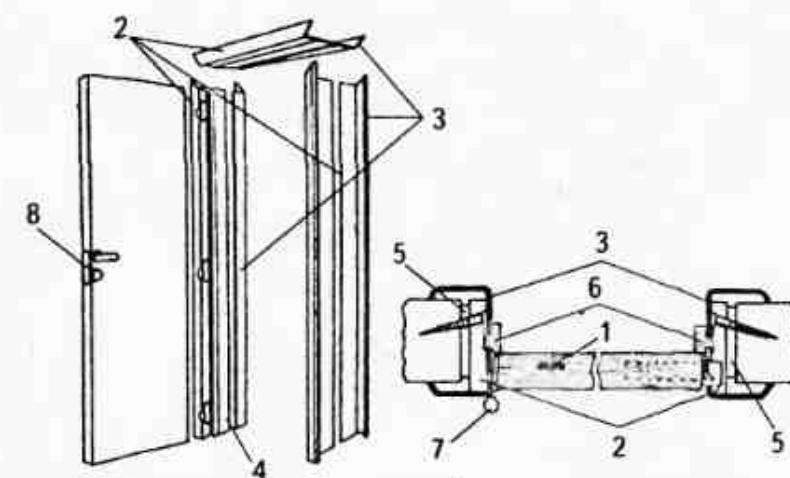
Установка готового комплекта: 1 — дверь; 2 — коробка с пригнанным наличником; 3 — наличник; 4 — необработанная древесина; 5 — уплотнитель; 6 — стопоры двери; 7 — петли; 8 — щеколда и замок
